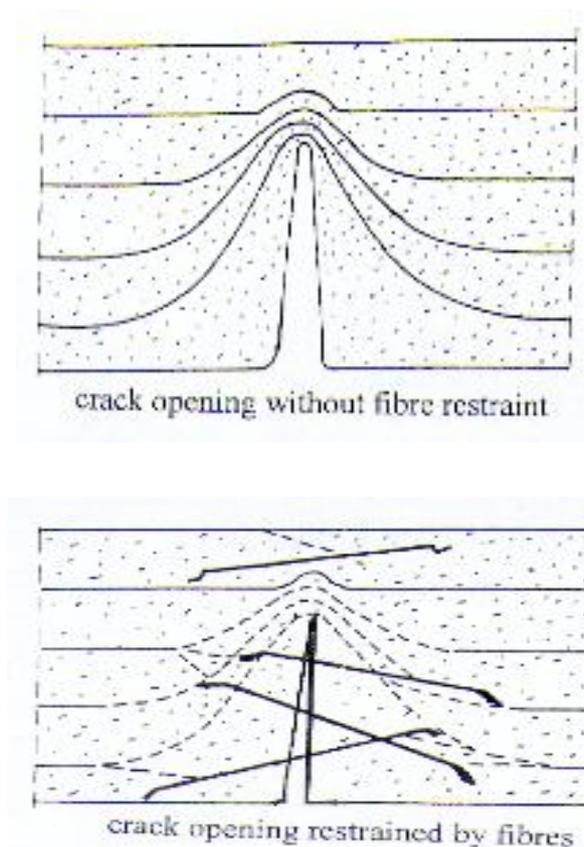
Effet de retardement de la fissuration avec fibres et béton
